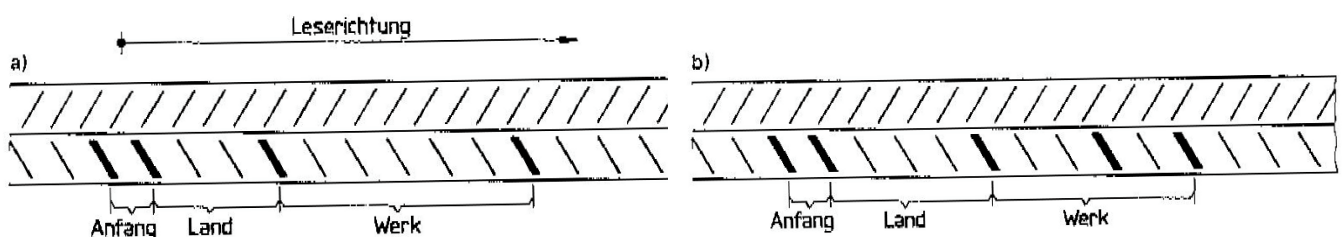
Kennzeichnung von Betonstabstahl BSt 420 S
